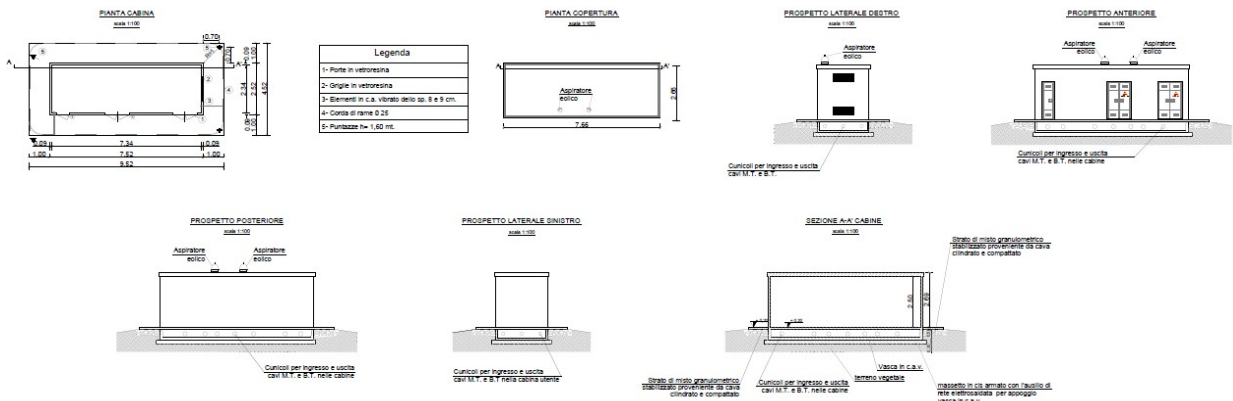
Pianta e sezione della cabina di raccolta e controllo
